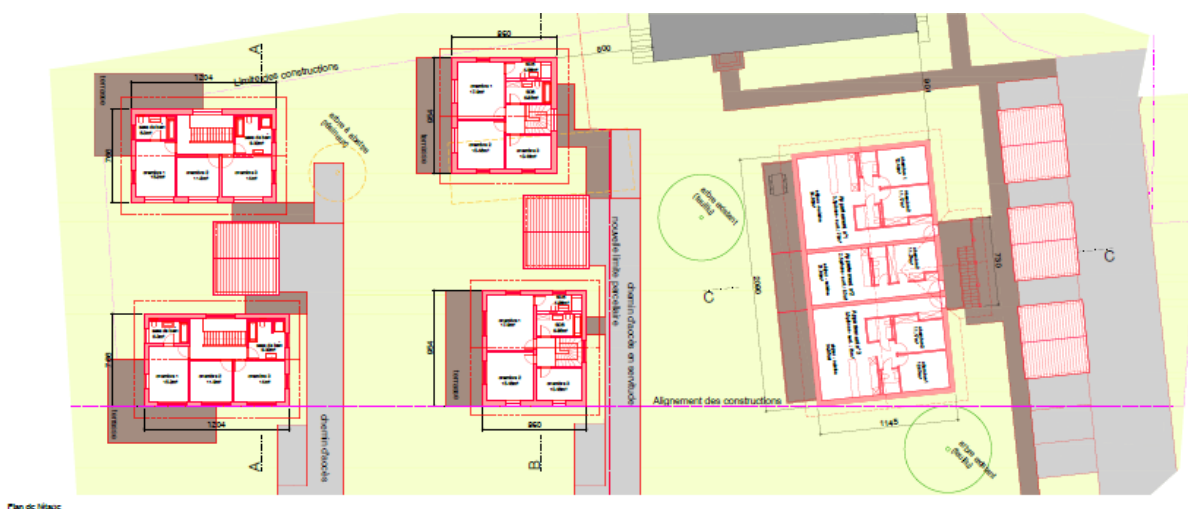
Extrait du projet de construction sur la parcelle n°31
